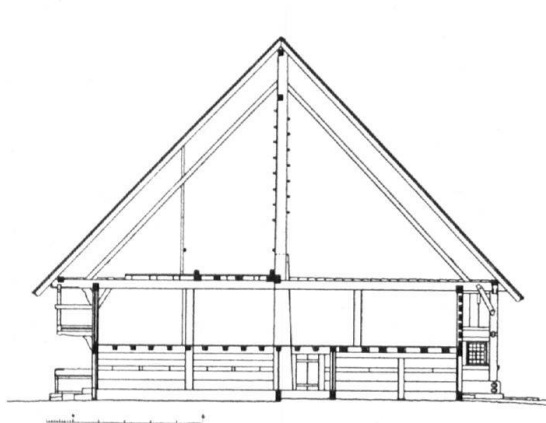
Querschnitt zu Bild 8. — Fig. 9. Première coupe
